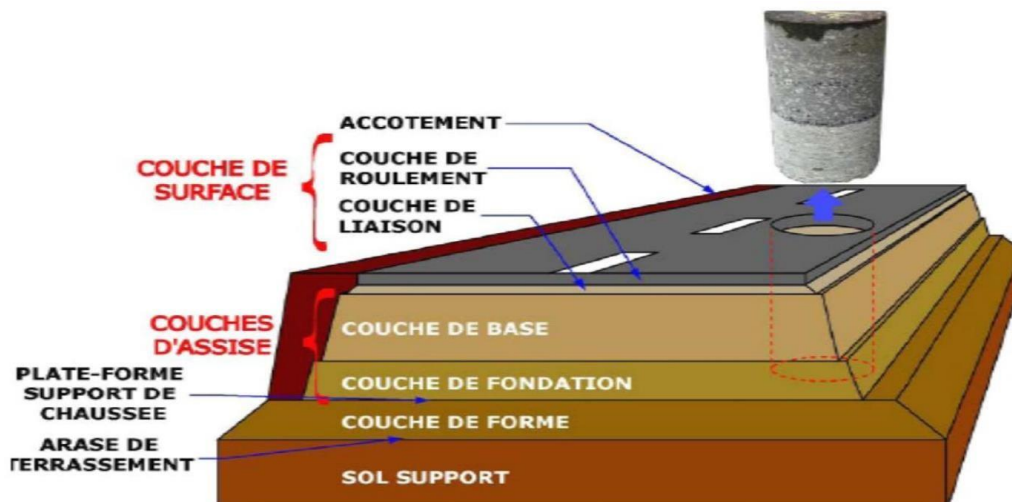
Les couches de la chaussée (Dokodzo 2013)
